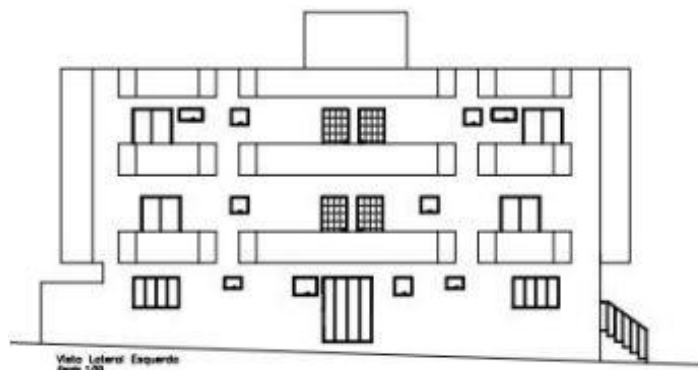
Fachada lateral da edificao no projeto visado. Fonte: Processo Administrativo n 137.001830/2001.
